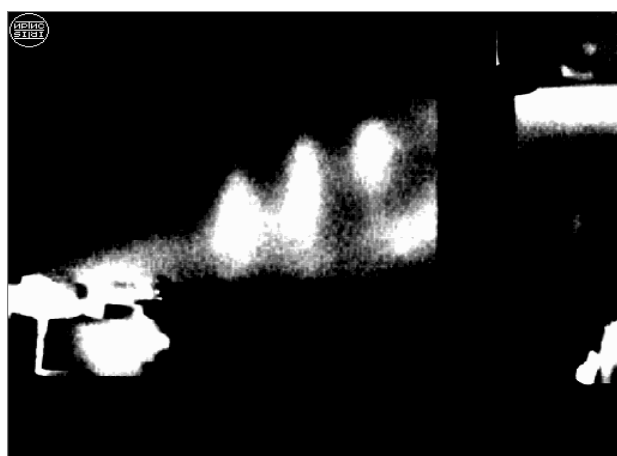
Термограмма железобетонной балки при $c_0/h_0 > 2,5$ перед разрушением
